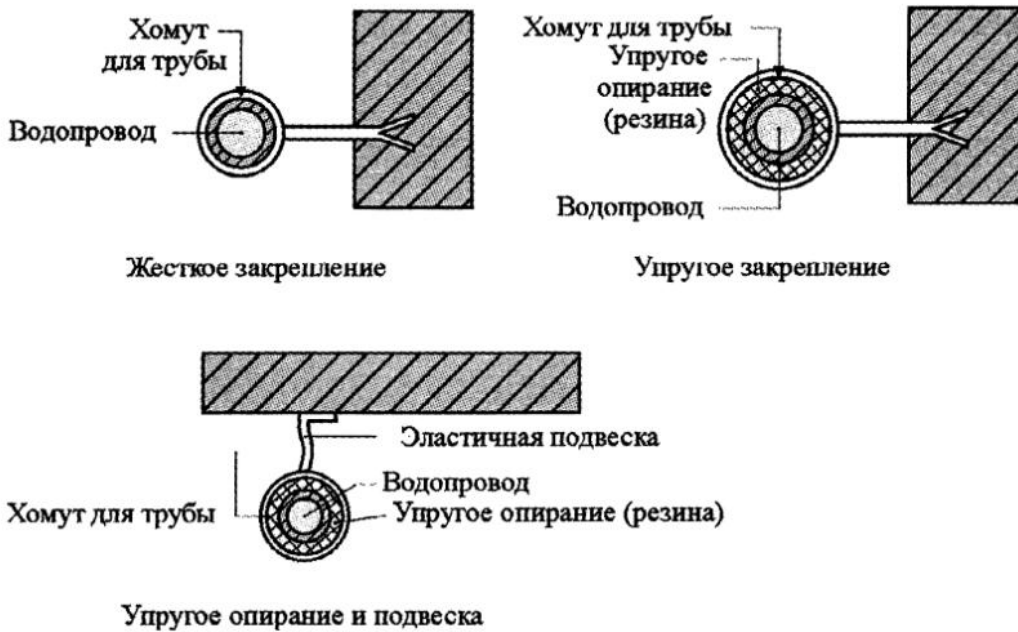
Схемы креплений трубопроводов к стене и перекрытию
